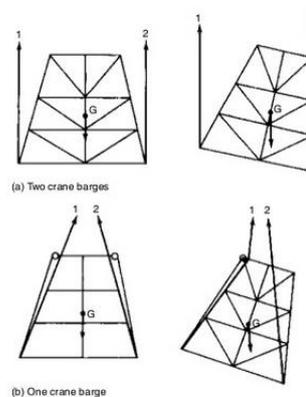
Levantar jacket con eslingas atadas debajo del centro de gravedad, con uno o dos grúas. Fuente: *Construction of Marine and Offshore Structures*.
